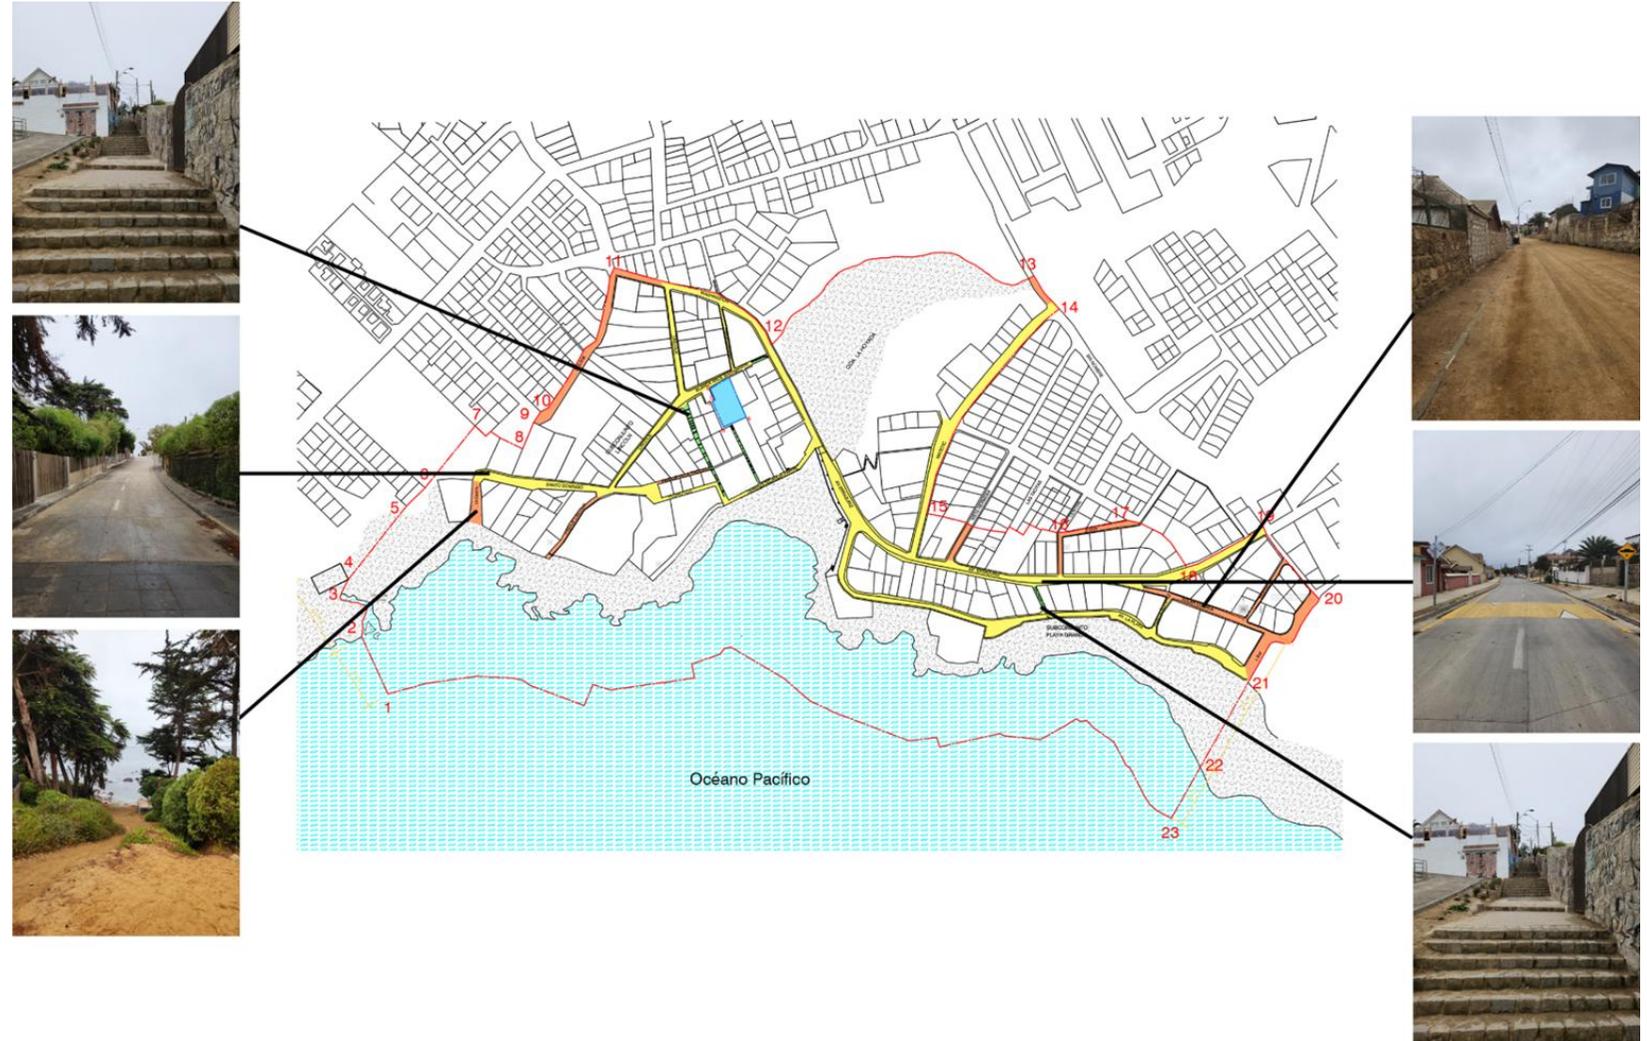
Situación actual del pavimento con fotografías que reflejan su estado, 2023, Elaboración propia CMN
